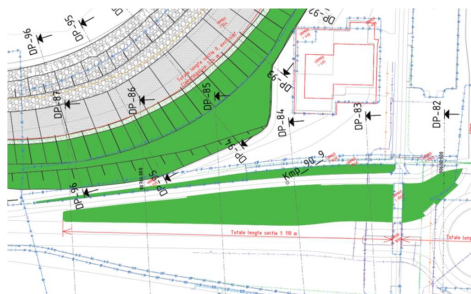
VO-ontwerp voor sectie 0, aansluiting met Westelijke Havendam
